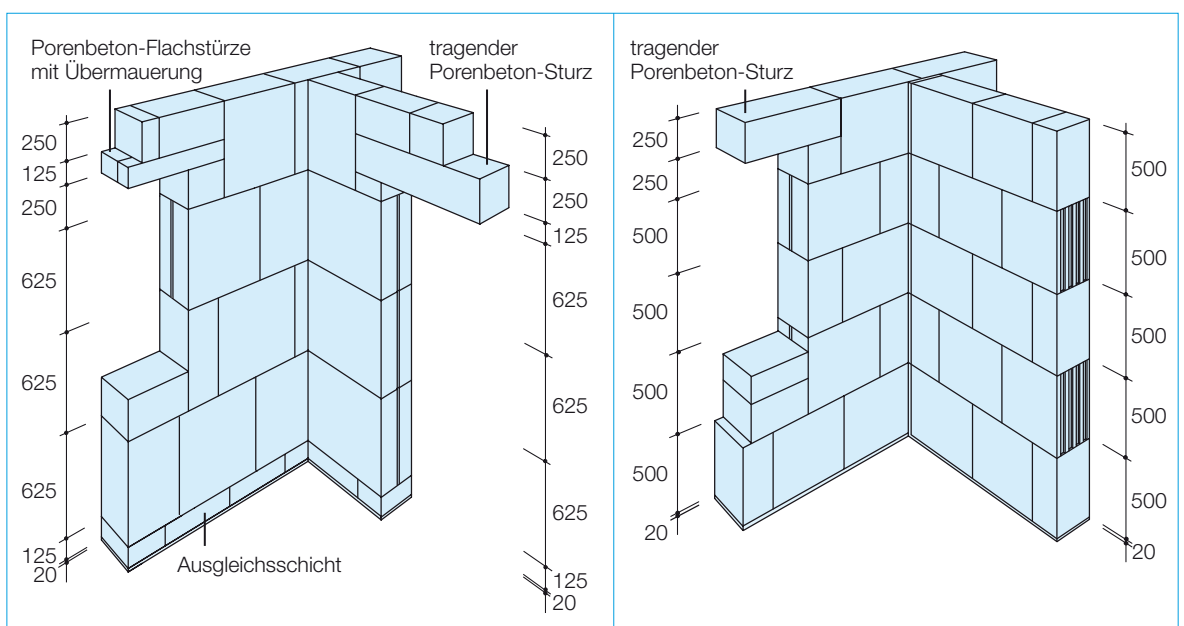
Porenbeton-Planelemente; Anlegen einer Höhenausgleichsschicht
